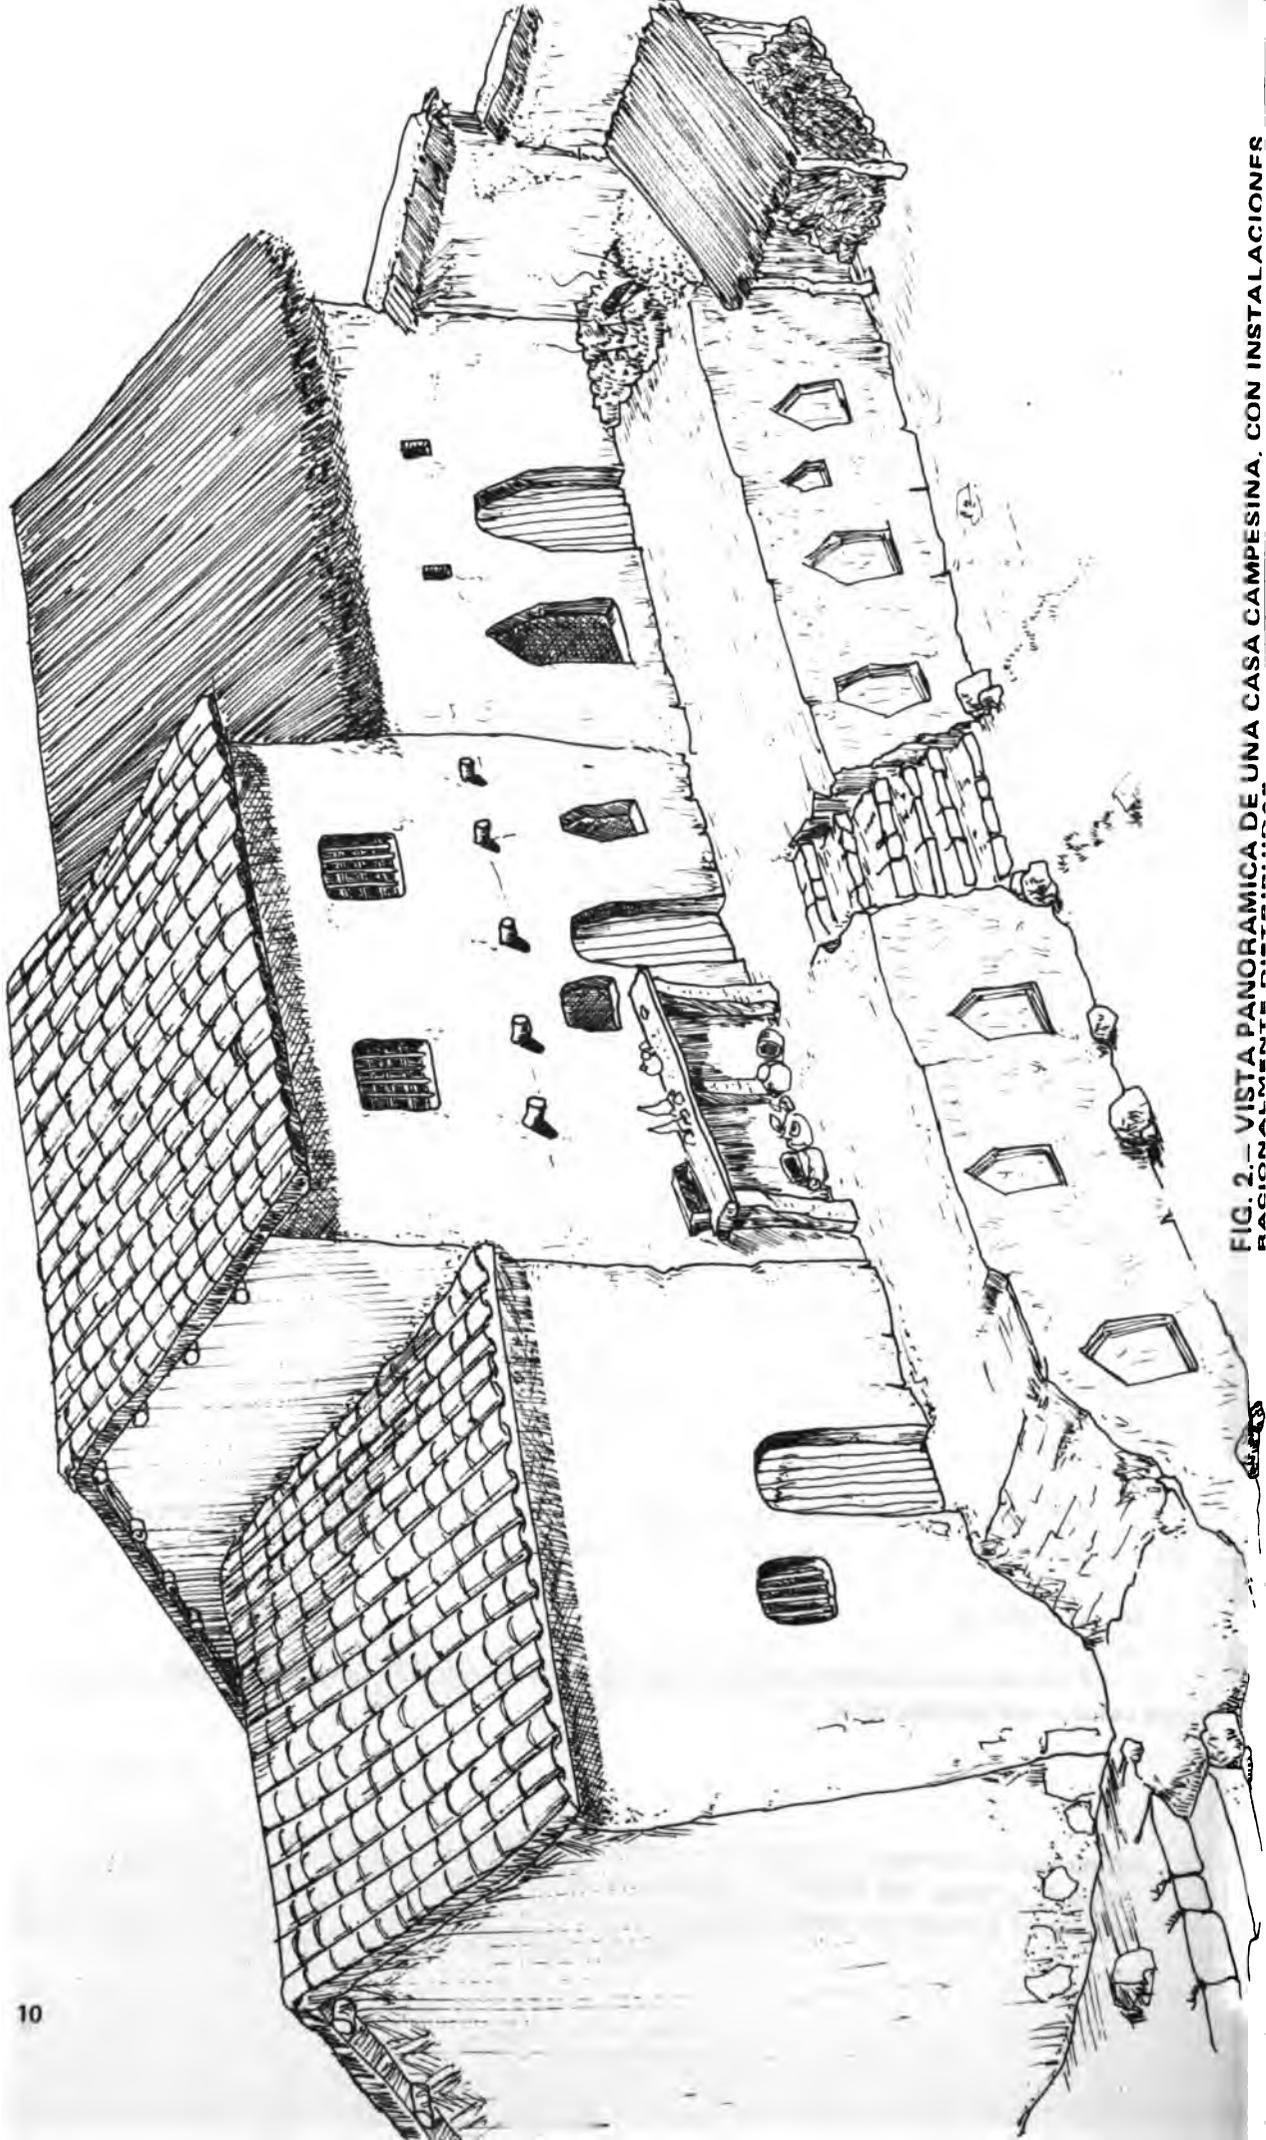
VISTA PANORAMICA DE UNA CASA CAMPESINA, CON INSTALACIONES RACIONALMENTE PLANIFICADAS.
